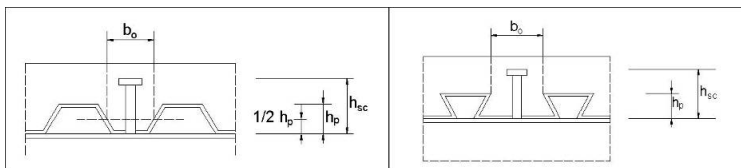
(b) - Disposizione della lamiera grecata rispetto al profilo in acciaio
